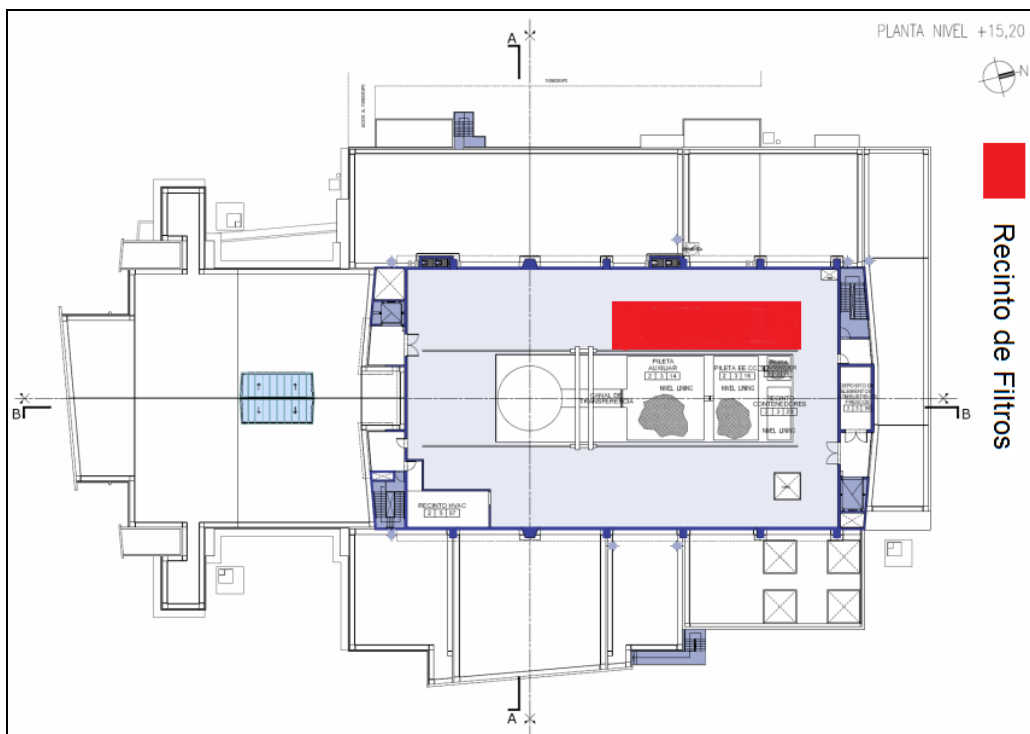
Lay Out Vista Nivel +15.20 metros
